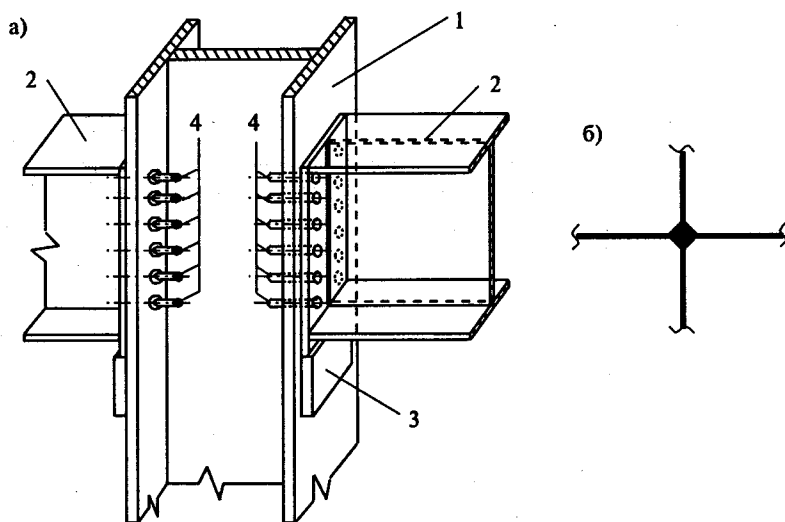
Жесткое прикрепление балок к стальной колонне сбоку: а) схема опирания балок; б) расчетная схема сопряжения колонны и балок; 1 — колонна; 2 — балки; 3 — опорный столик колонны; 4 — болты (гайки и головки болтов не показаны)
